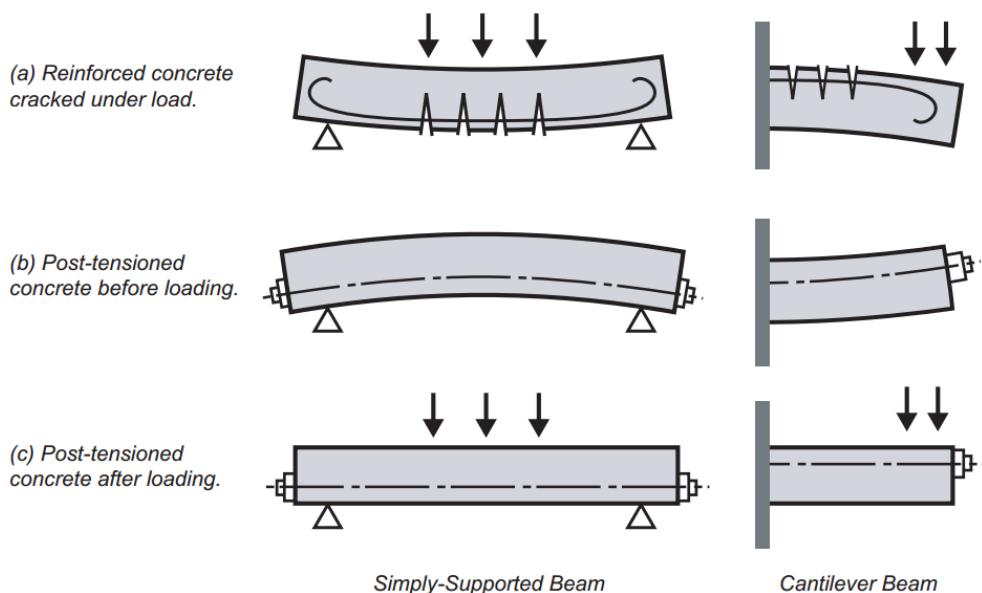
Comparación de vigas de concreto reforzado y pretensado.
